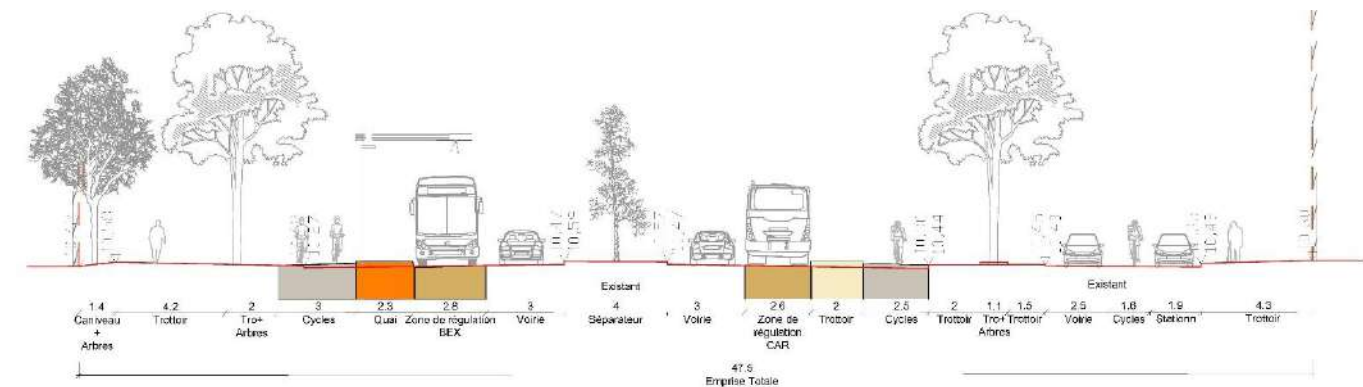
Coupe type sur la rue Générale de Larminat en section courante
